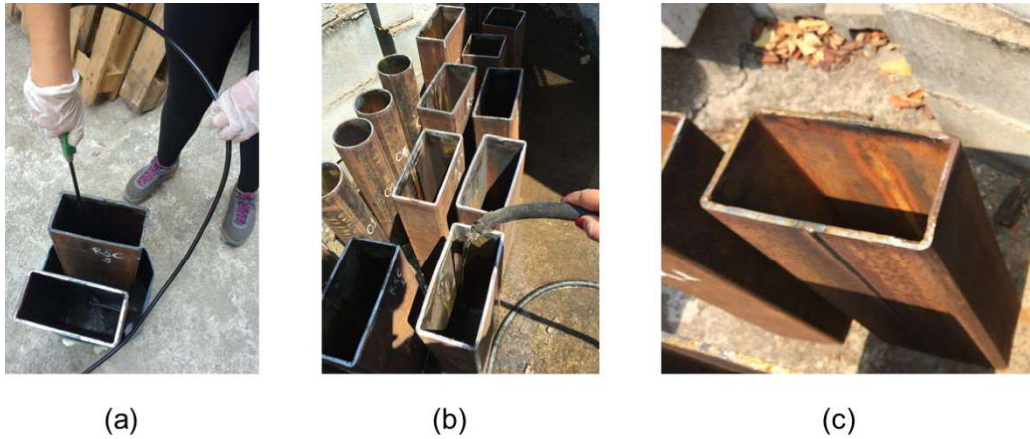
Aplicação da solução de Cloreto de Ferro: a) aplicação; b) lavagem; c) concreto fabricado.
